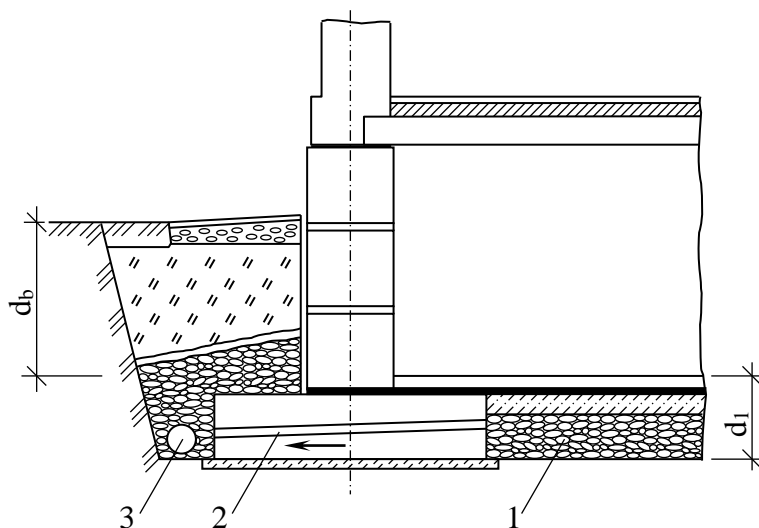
Улаштування пластового та кільцевого дренажу: 1 – пластовий дренаж; 2 – трубки для з'єднання дренажів; 3 – кільцевий дренаж
